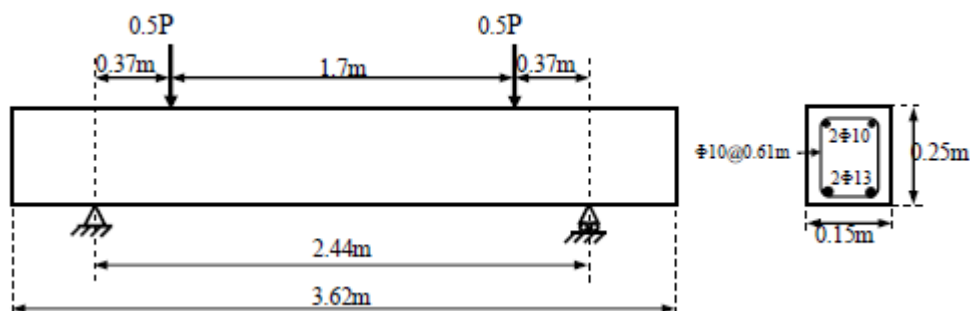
Dimensões, modelo estático e reforço da viga B1 [50]
